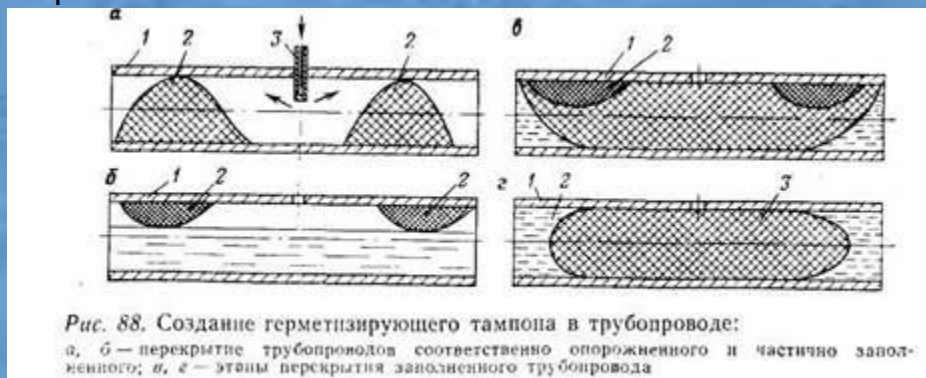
Создание герметизирующего тампона в трубопроводе:
